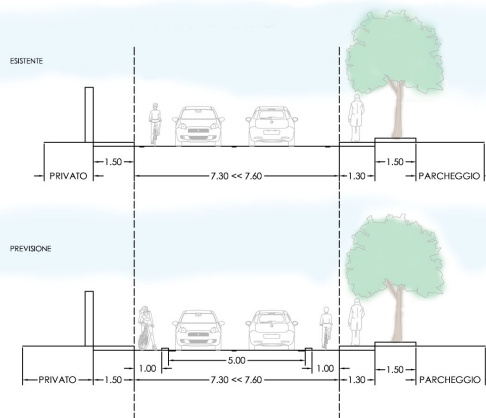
Sezioni esistente e proposta, via Pietro Rovelli, parte ad est dell'area - Sez 12
